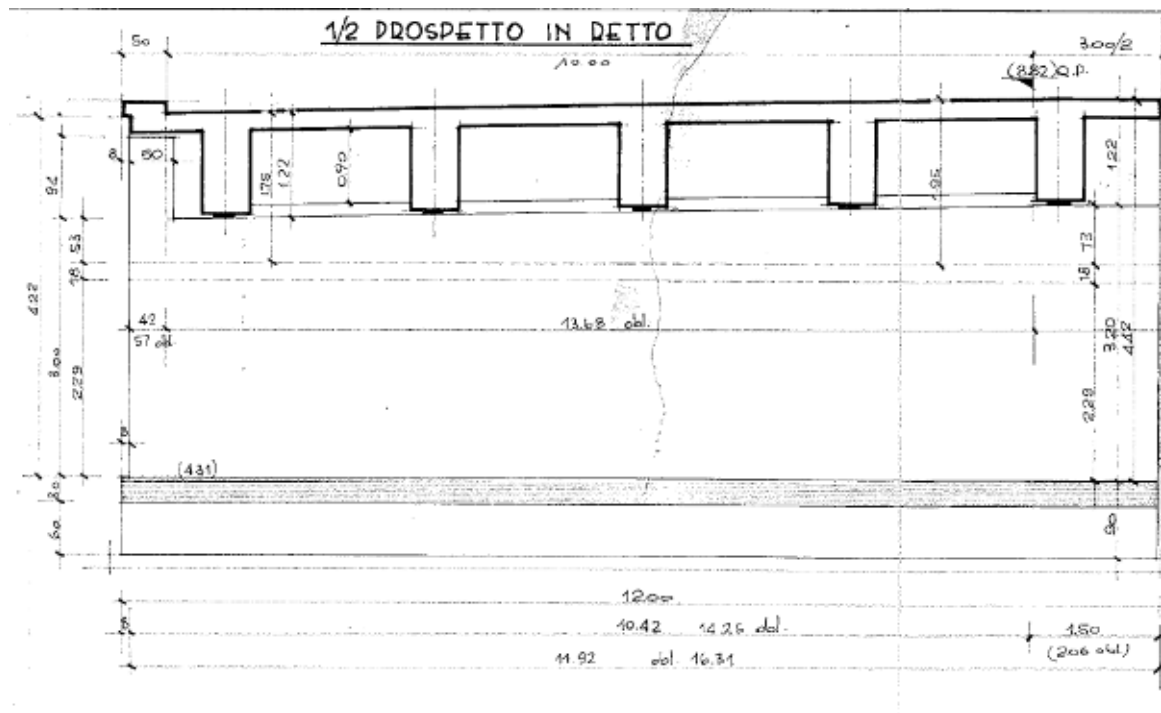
1/2 Prospetto spalla esistente
